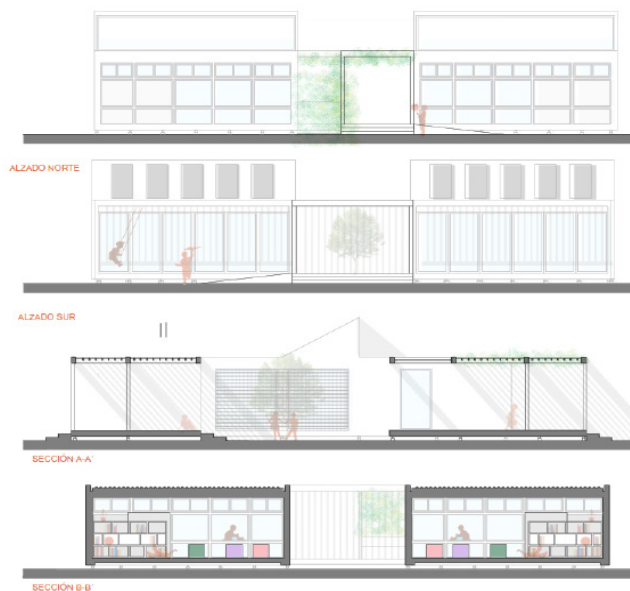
Planimetría de la propuesta de agrupación 1.
